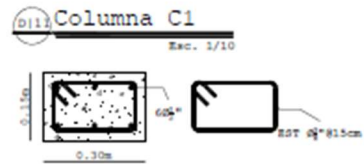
Diseño Estructural para Contenedores – Planta de Cimentación
